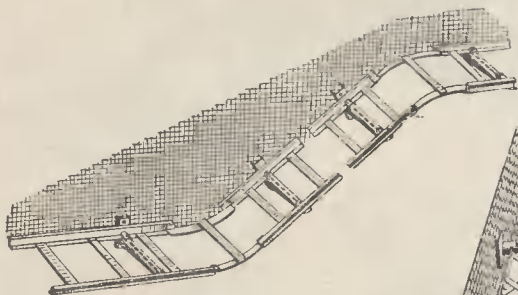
Горизонтальная установка на стене на кабельных конструкциях перфорированных лотков.
